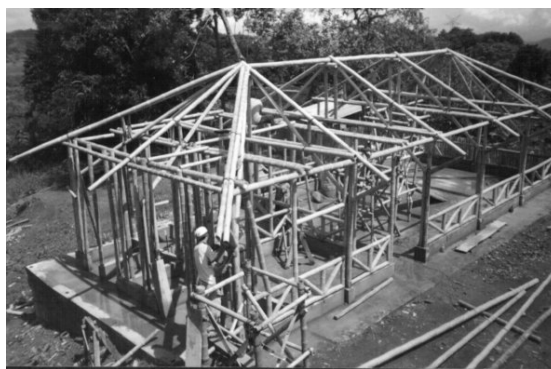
Casa Habitación (desplante de columnas y vigas de Bambú)¹
